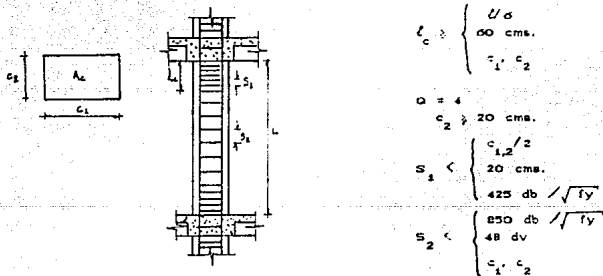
Requisitos geométricos y para refuerzo transversal en columnas de concreto
